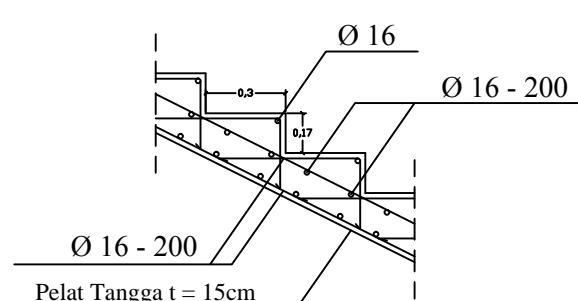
DETAIL POTONGAN TANGGA TYPE 1 BAGIAN KIRI
